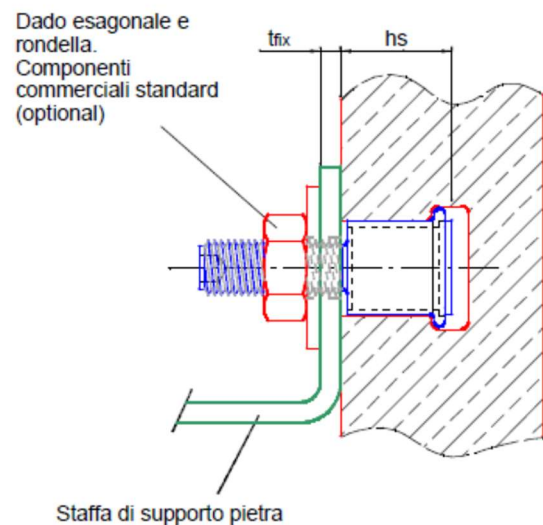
Uso previsto dell'ancorante GSE: collegamento con staffa/sottostruttura metallica
